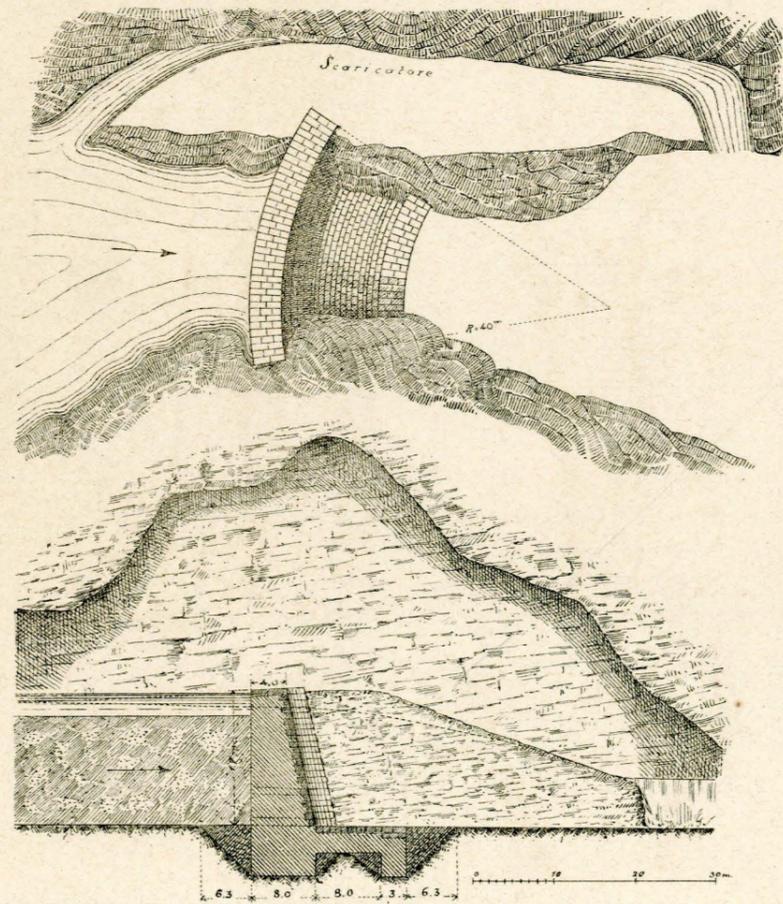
a 15. - Serra Madruzzo: Prospetto a valle, sezione trasversale e piante.
